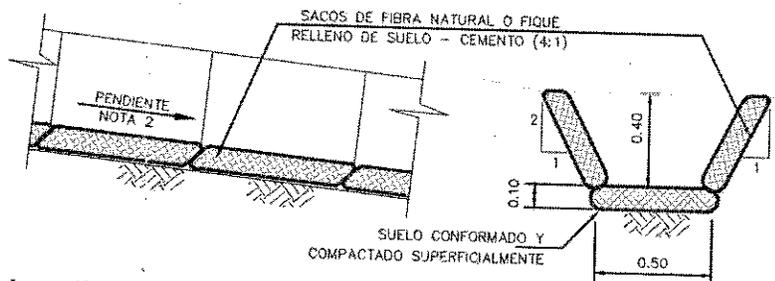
Sección transversal de la estructura del canal suelo cemento que se construirán para mejorar las condiciones de escorrentía en esa zona. Fuente Propia.
